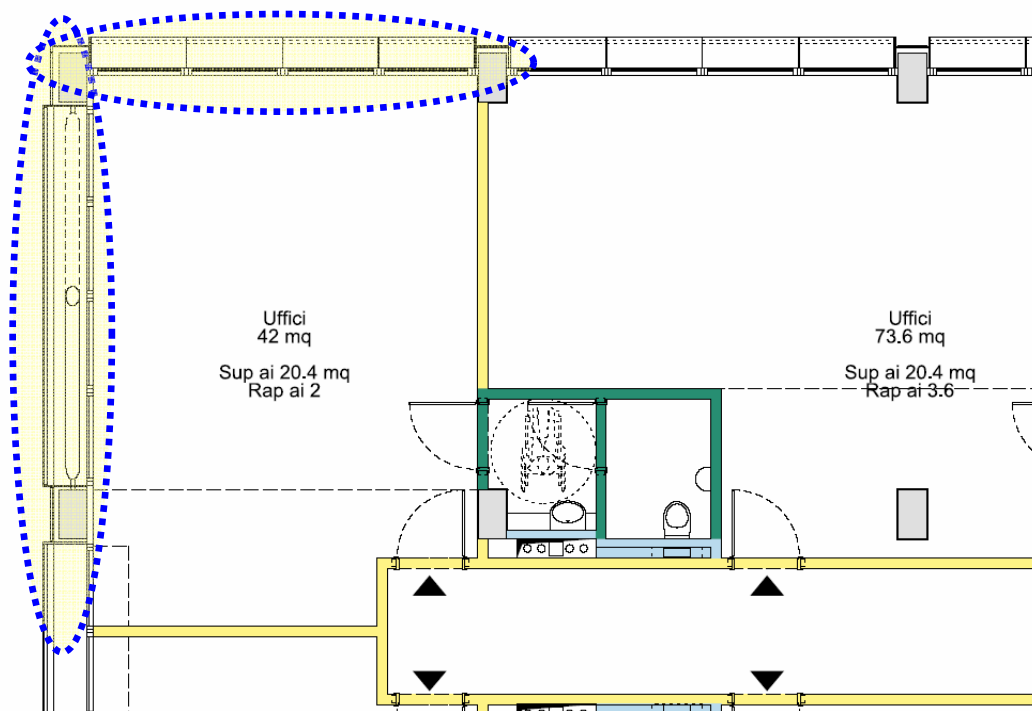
Indicazione in pianta della facciata oggetto di valutazione
